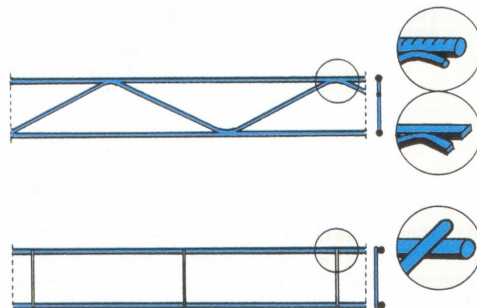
Exemplos de diferentes tipos de armaduras para paredes de alvenaria
